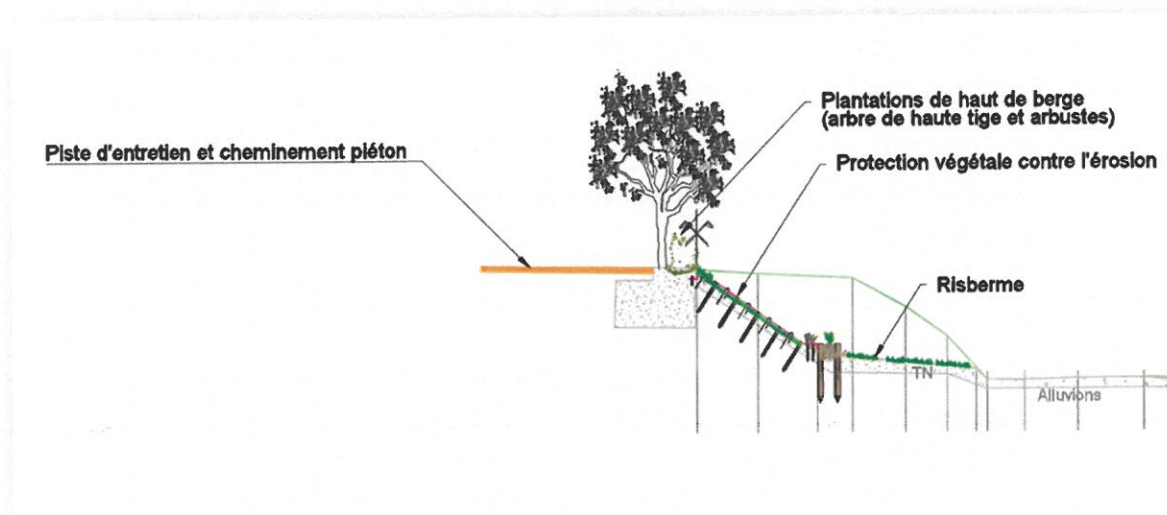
Coupe type des berges restaurées sur la Nartuby
